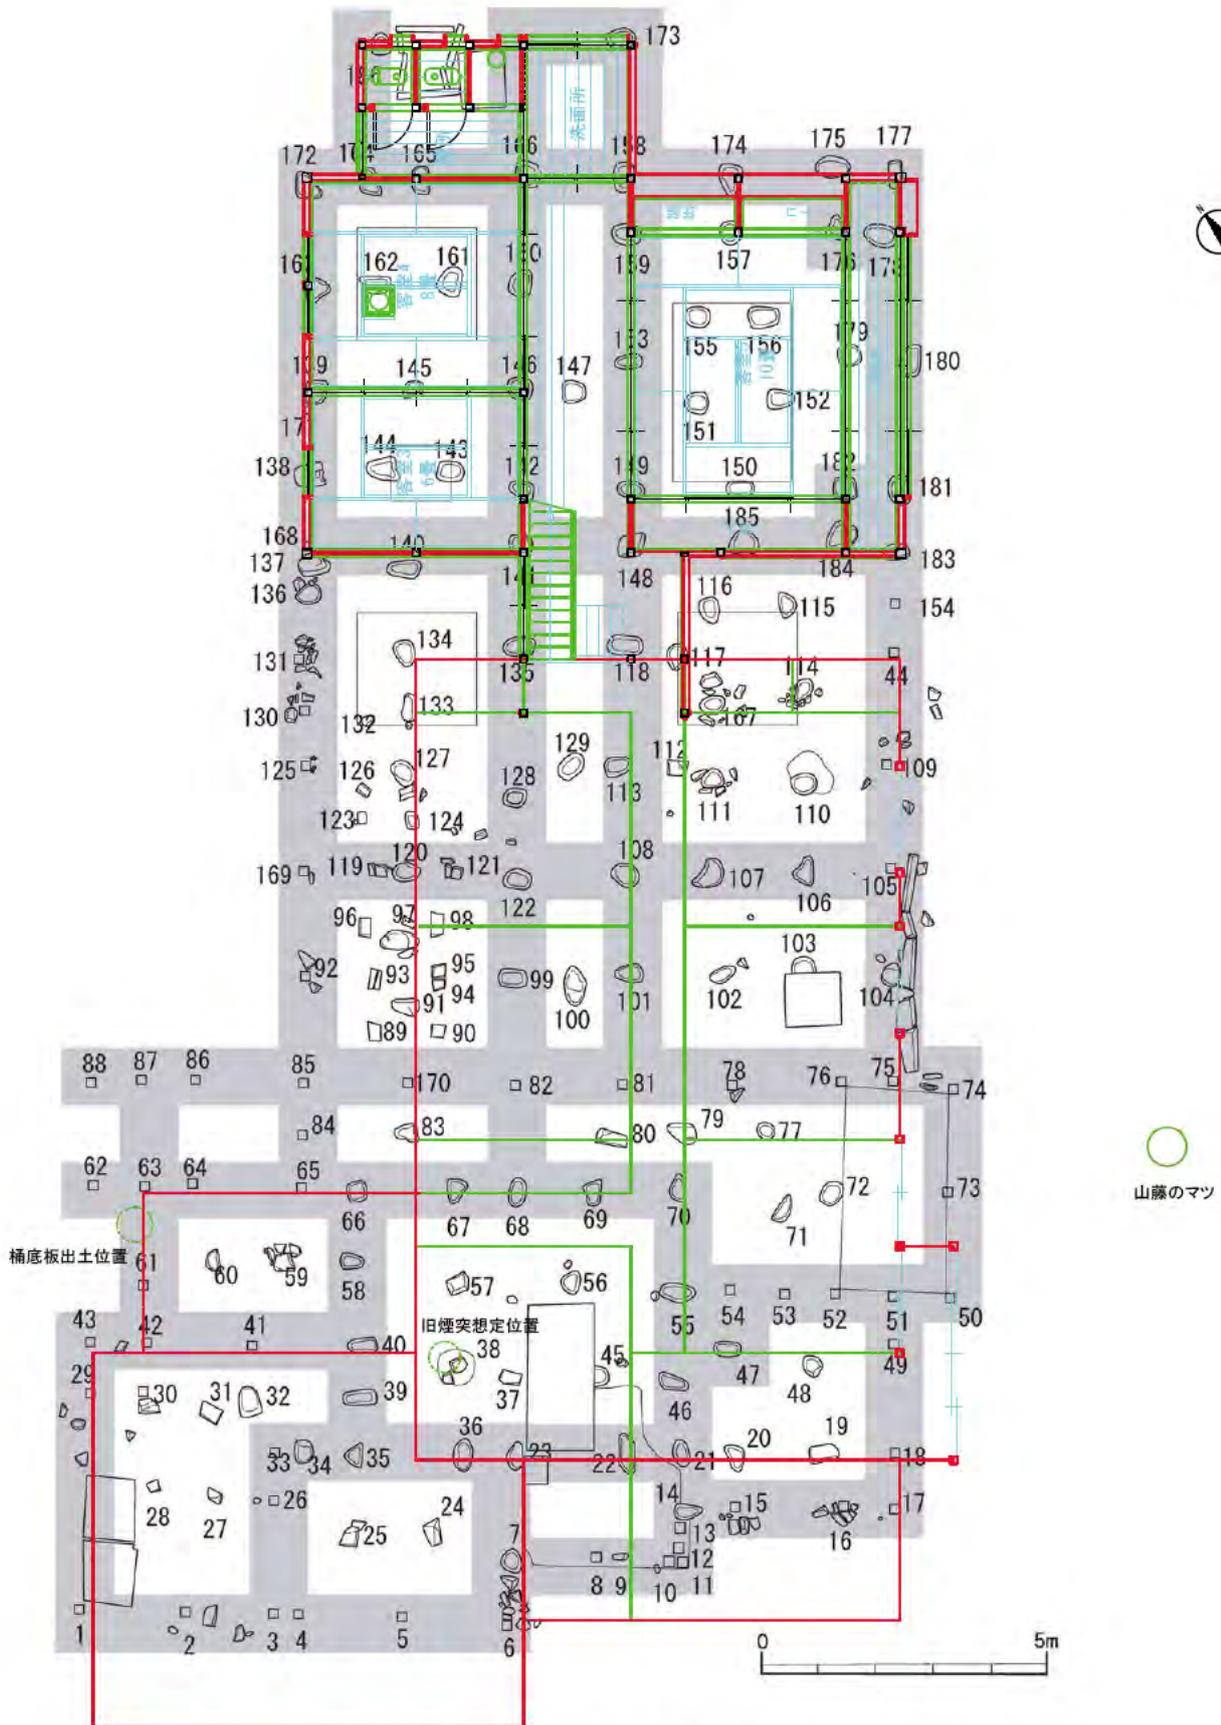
Ⅲ期建物推定平面図と遺構重ね図（グレー着色部は発掘調査範囲）
